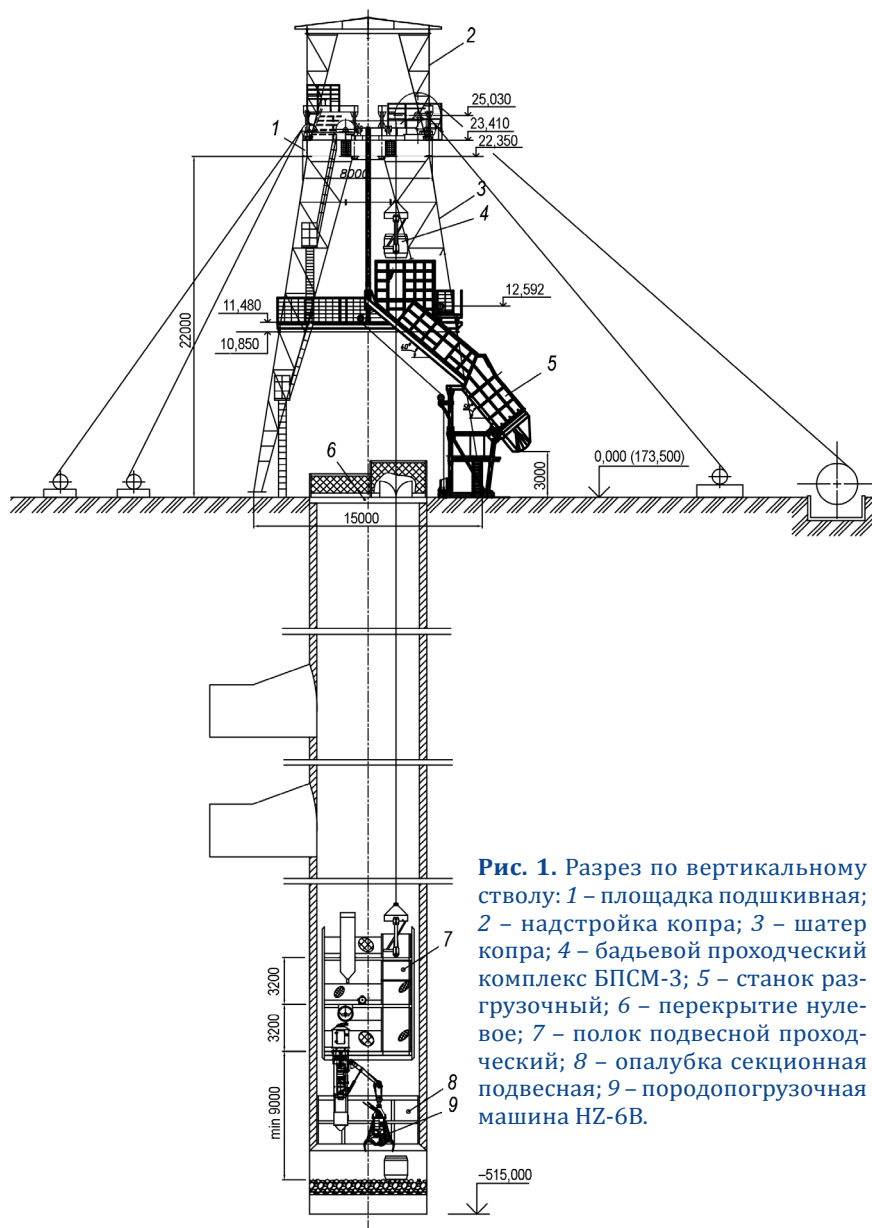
Разрез по вертикальному стволу: 1 – площадка подшивная; 2 – надстройка копра; 3 – шатер копра; 4 – бадьевого проходческий комплекс БПСМ-3; 5 – станок разгрузочный; 6 – перекрытие нулевое; 7 – полок подвесной проходческий; 8 – опалубка секционная подвесная; 9 – породопогрузочная машина НЗ-6В.
